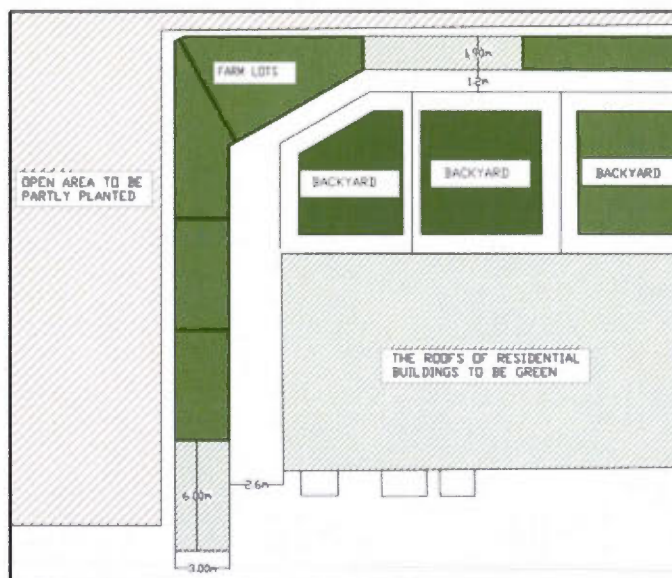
Détail du site plan proposé pour îlot n° 44
